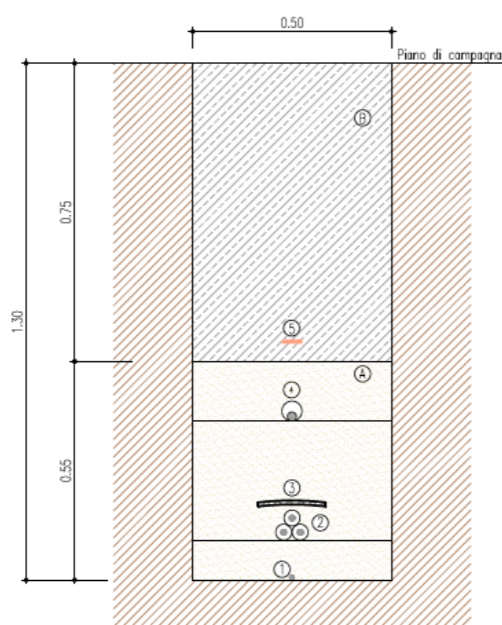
Planimetria del tracciato del cavidotto e sezioni tipo
